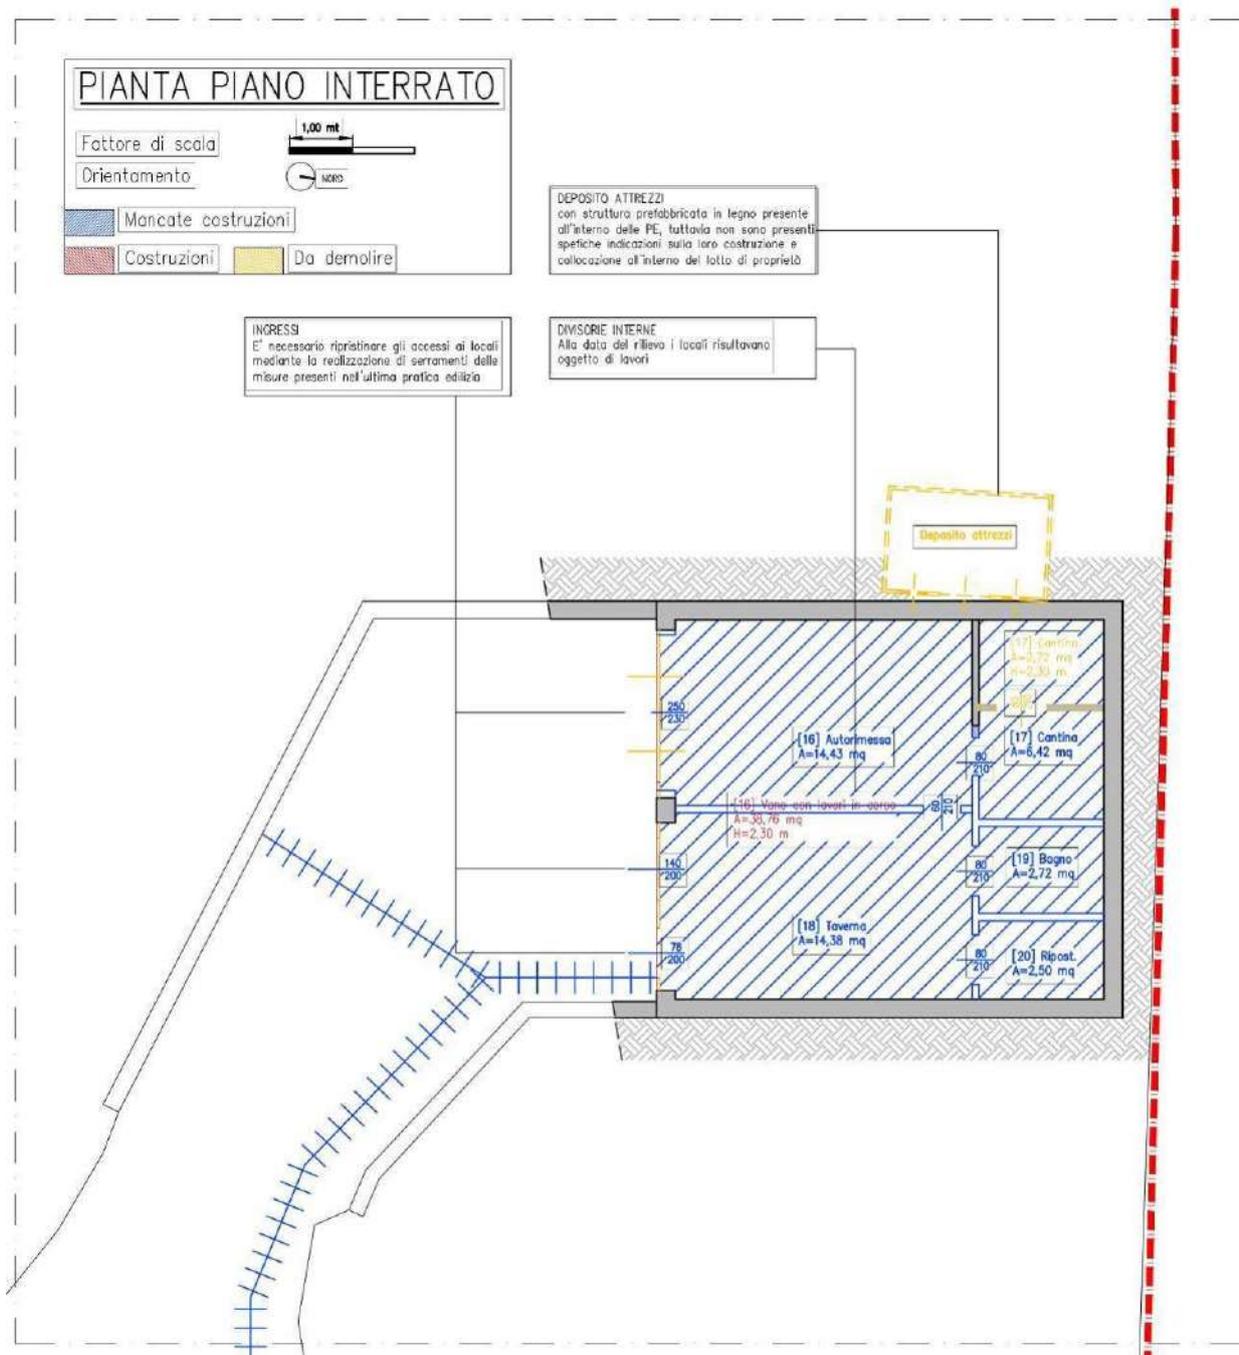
Pianta piano interrato autorimessa-taverna: confronto tra stato autorizzato e realizzato.
